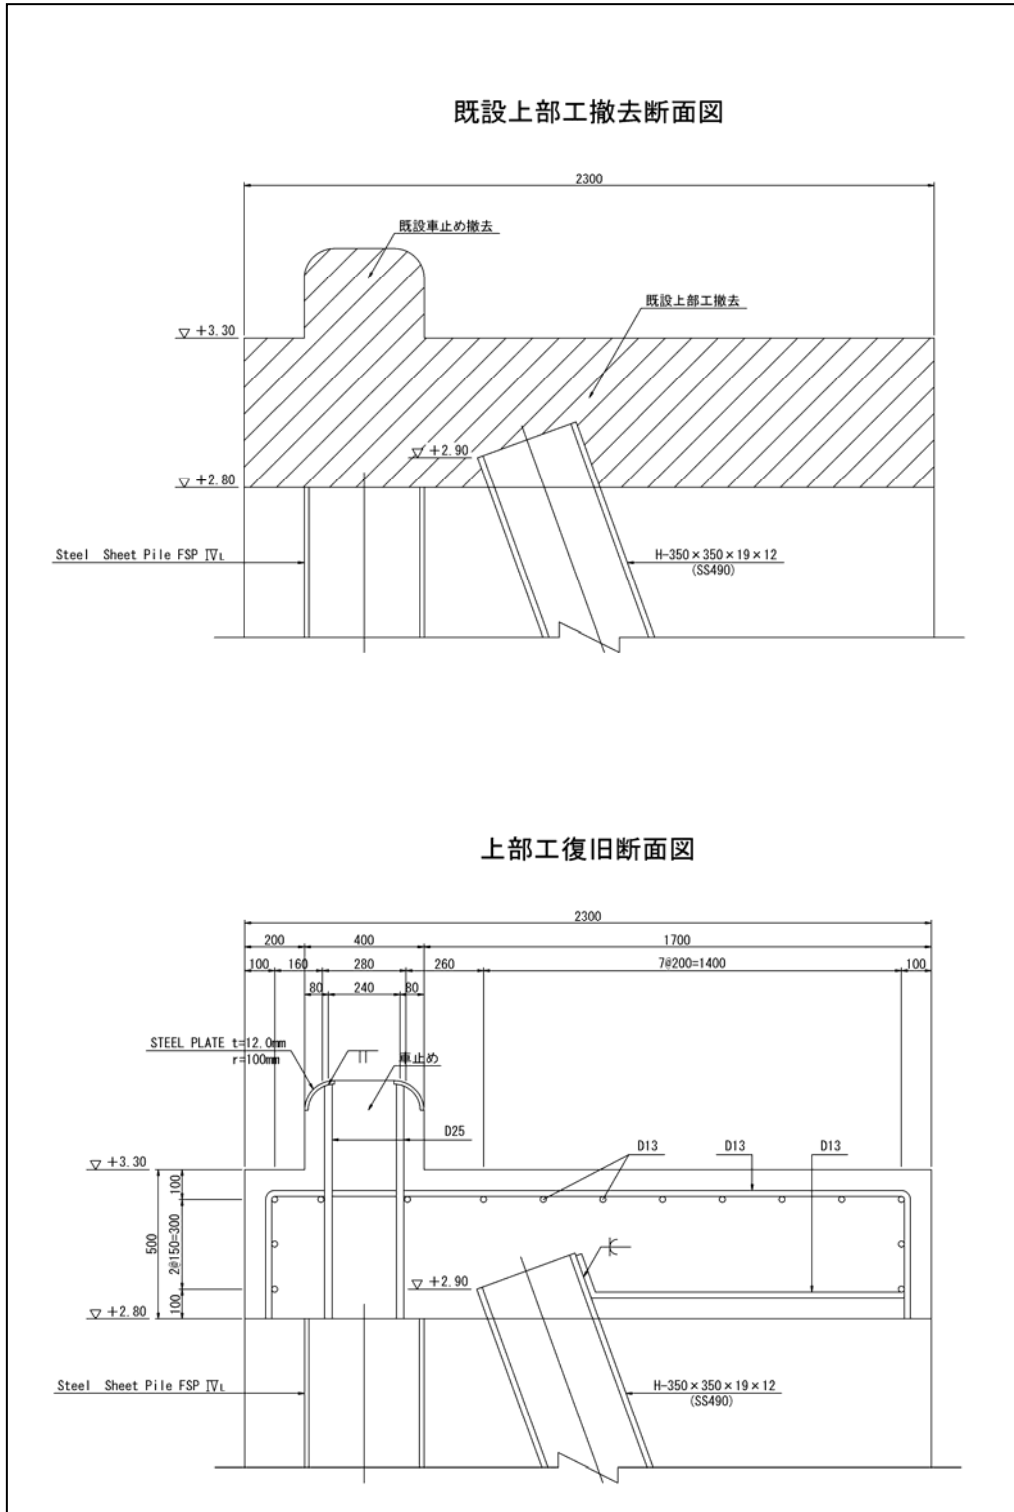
B岸壁上部工及び車止め改修計画標準断面図
